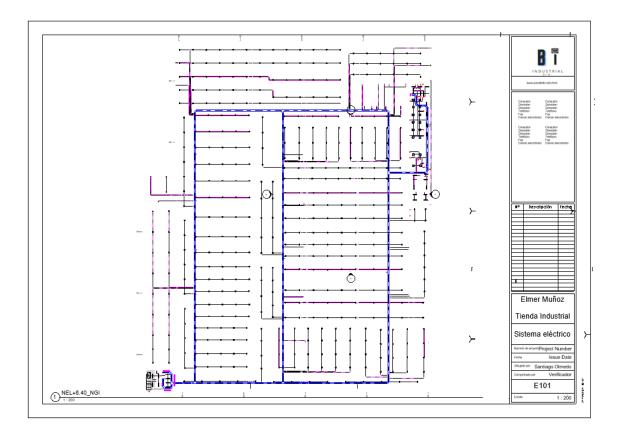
Ejemplo plano sistema eléctrico. Elaboración propia
